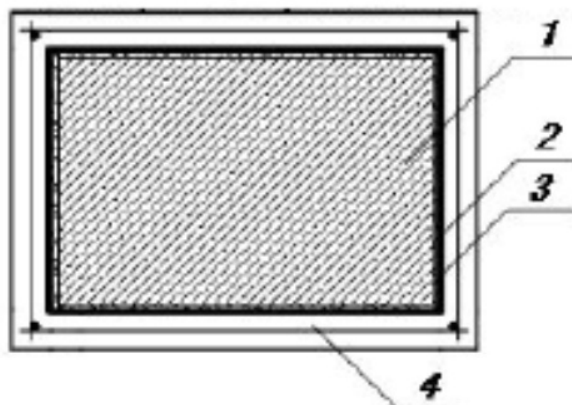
Железобетонная обойма и прослойка из жидкого стекла со стеклотканью:
